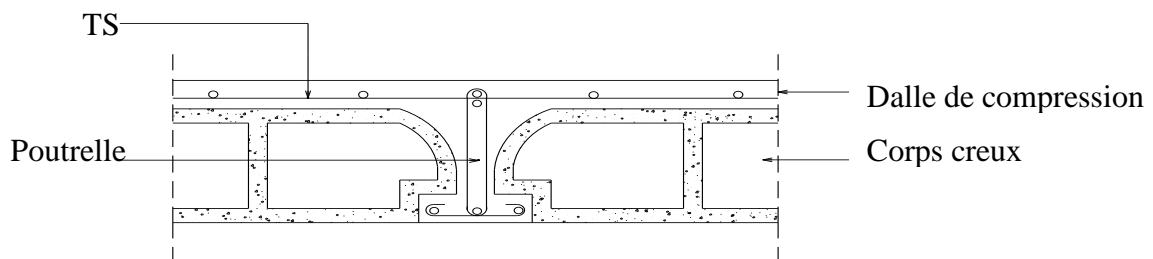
Coupe transversale d'un plancher à corps creux.
